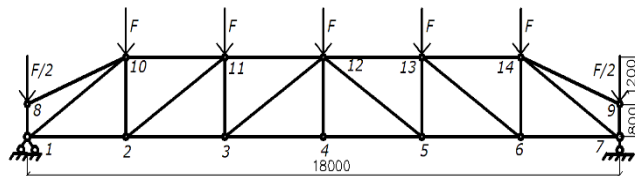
Нумерация узлов, распространяющаяся на все варианты ферм (в треугольной ферме 4 стержня отсутствуют)
